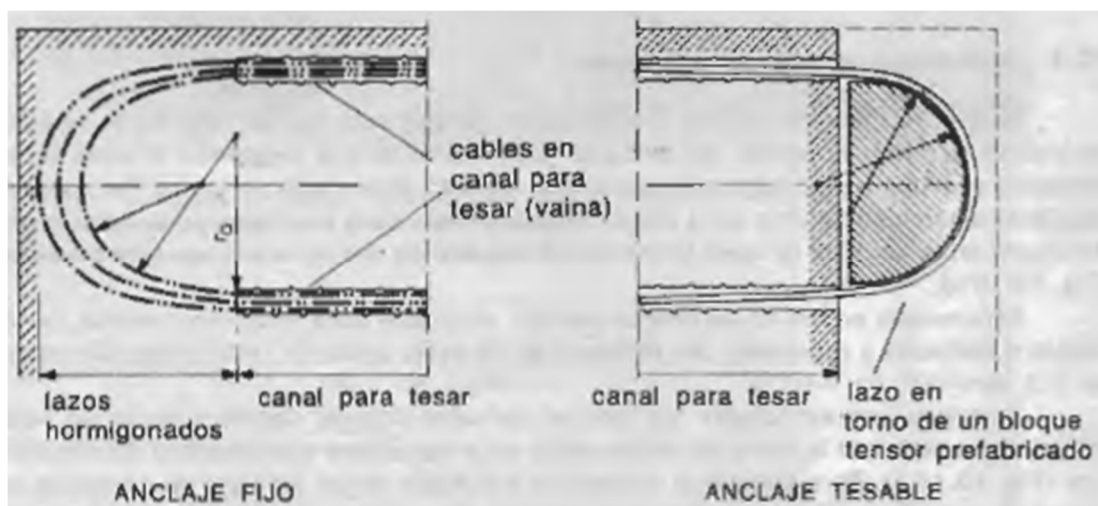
Anclaje en lazo entre dos canales de tesado, colocado alrededor de un bloque tensor prefabricado. Fuente: Hormigón Pretensado Tomo V – Leonhardt. Página 85
